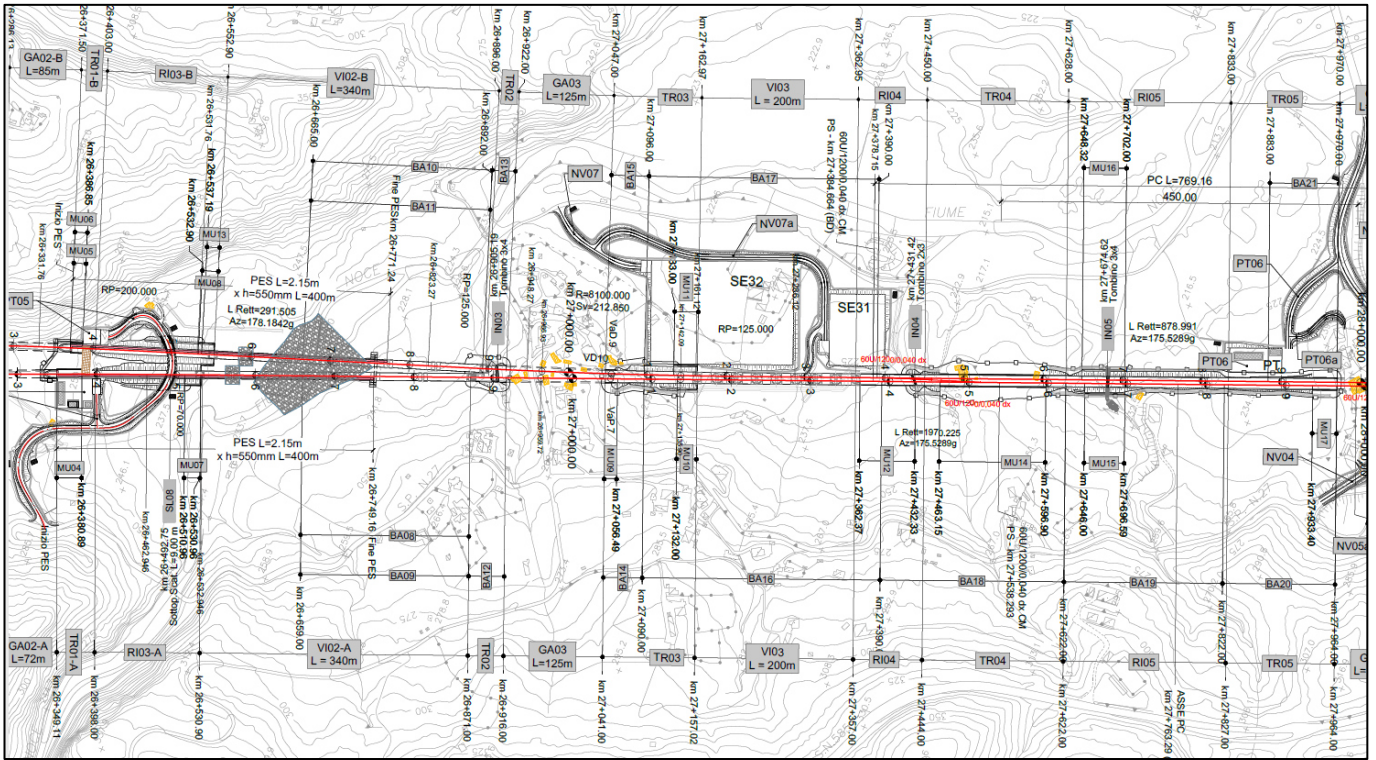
Planimetria di progetto da km 26+349 al km 27+964 BP
